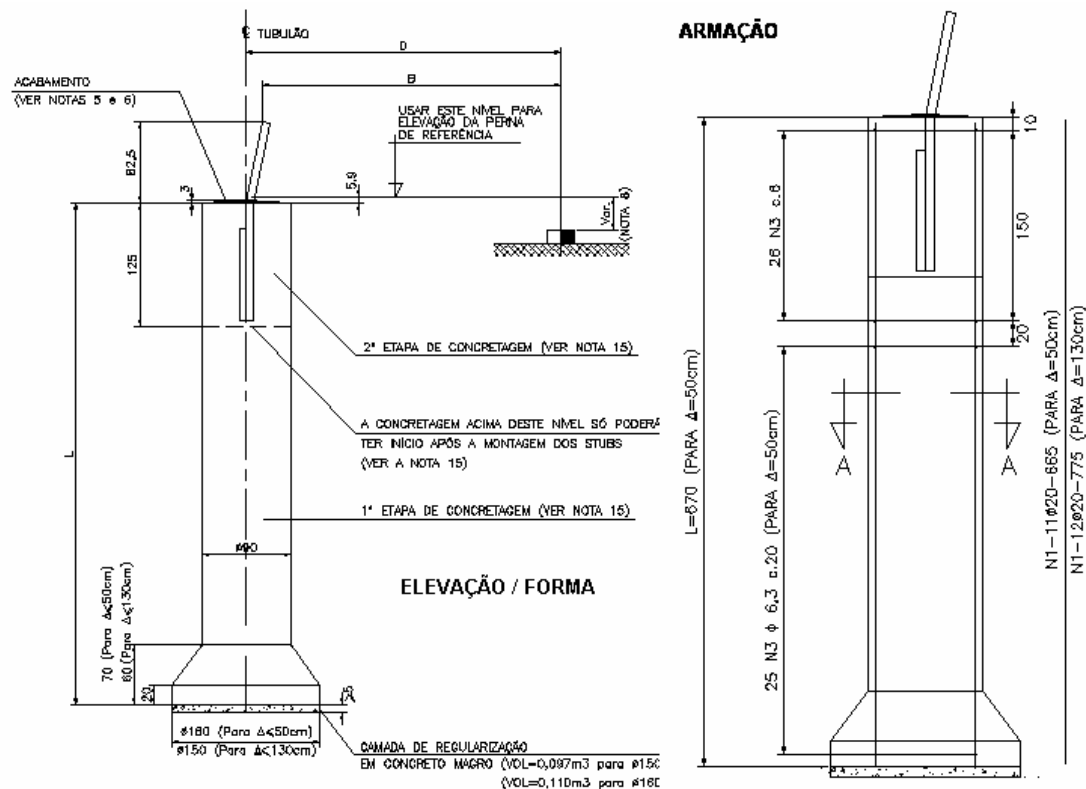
Elevação, forma e armação da fundação em tubulão para torre autoportante de suspensão na LT Chavantes-Botucatu.
